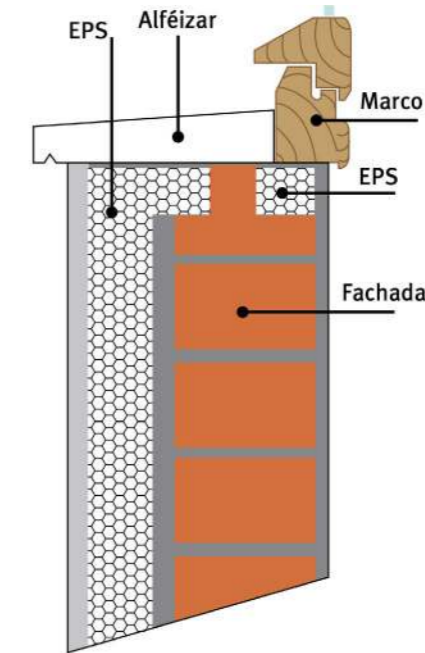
Detalle 2. Sistema SATE. Encuentro de fachada con alféizar.
